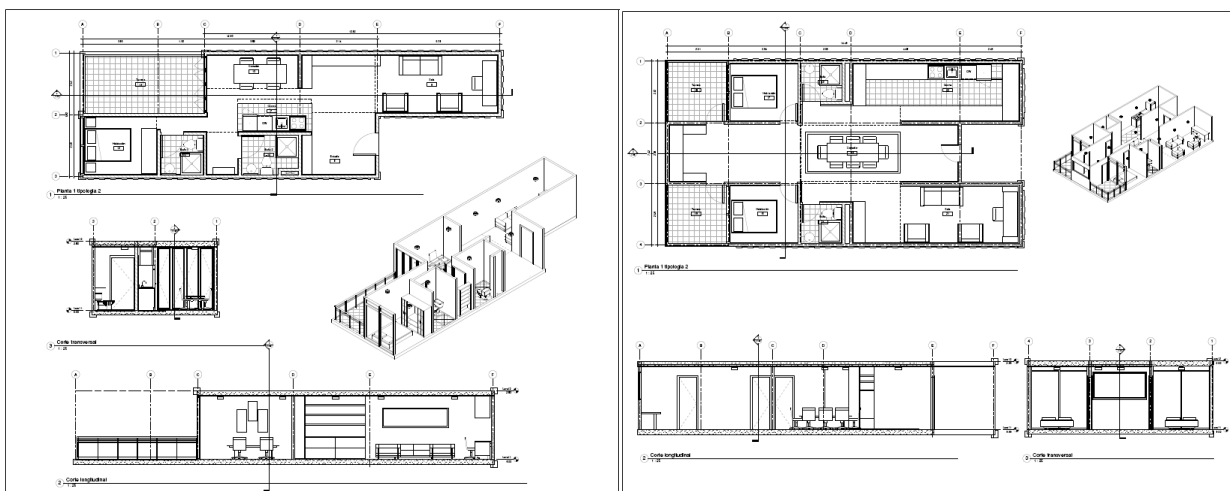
Anexo de plantas, cortes y vistas 3d de la tipología 2 y 3 del proyecto torres Jaquez- Fuente propia.
